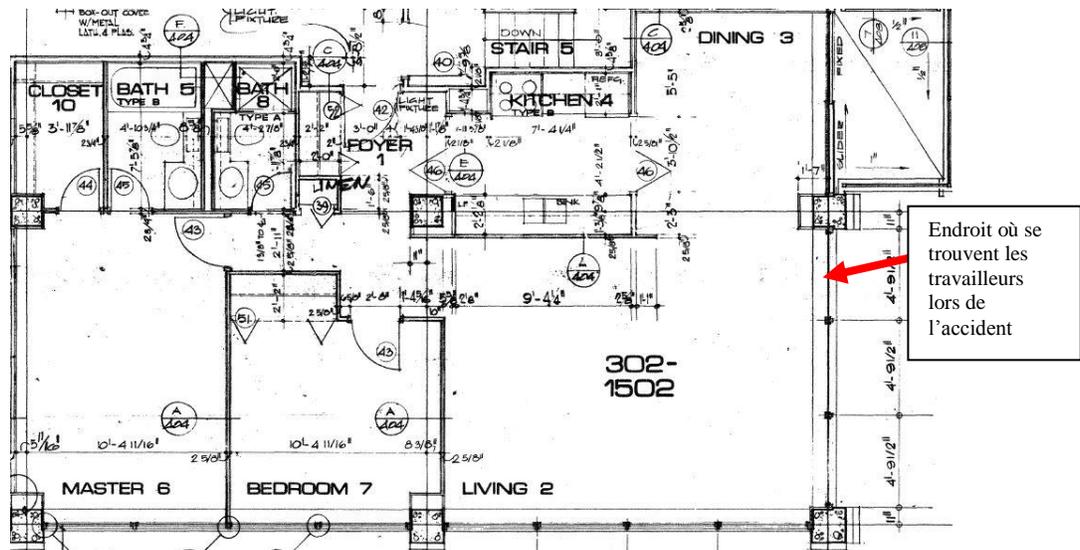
Plan type de l'appartement (Source : Structures Métropolitaines inc.)
